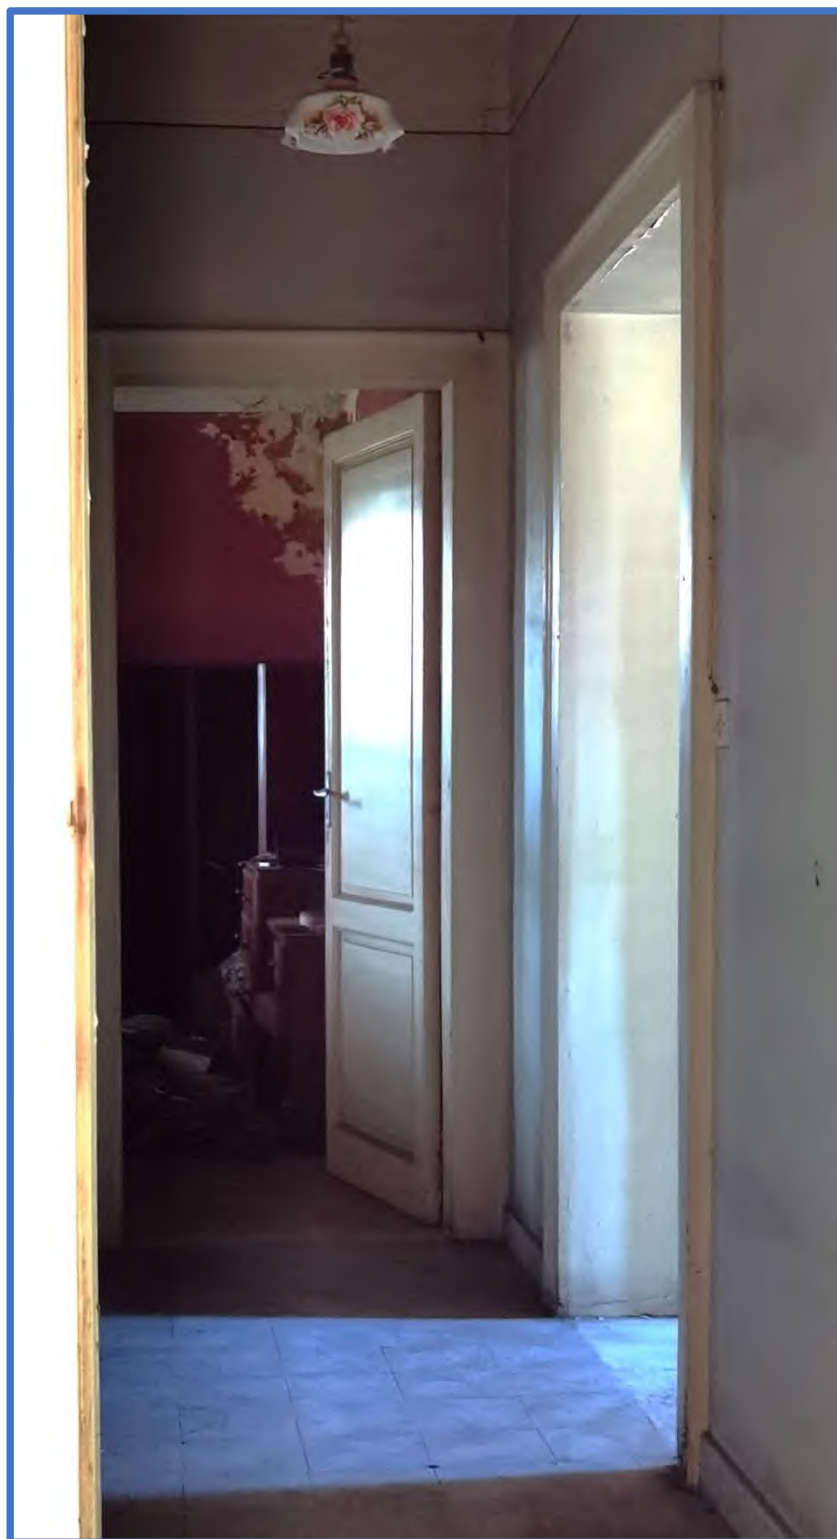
Vista disimpegno. In fondo la stanza da letto matrimoniale.
